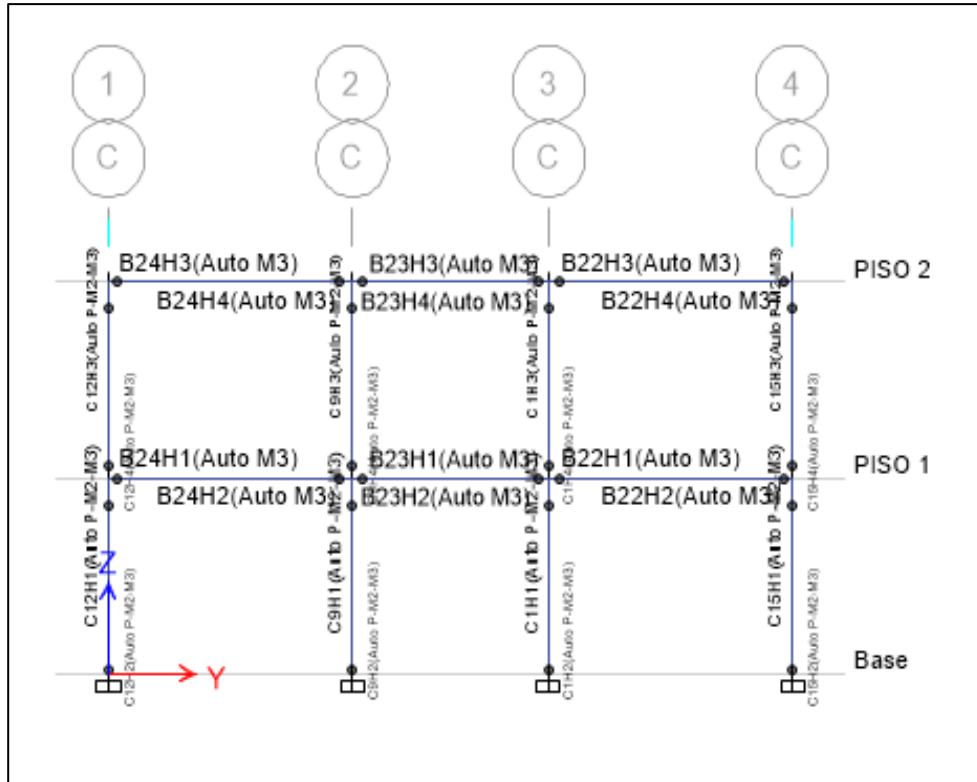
Ubicación de las rótulas plásticas en las vigas en el eje y-y. Fuente: Elaboración propia.
